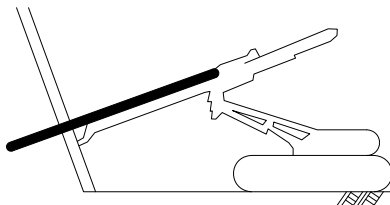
施工手順 (のり面工が吹付けコンクリートの場合)
